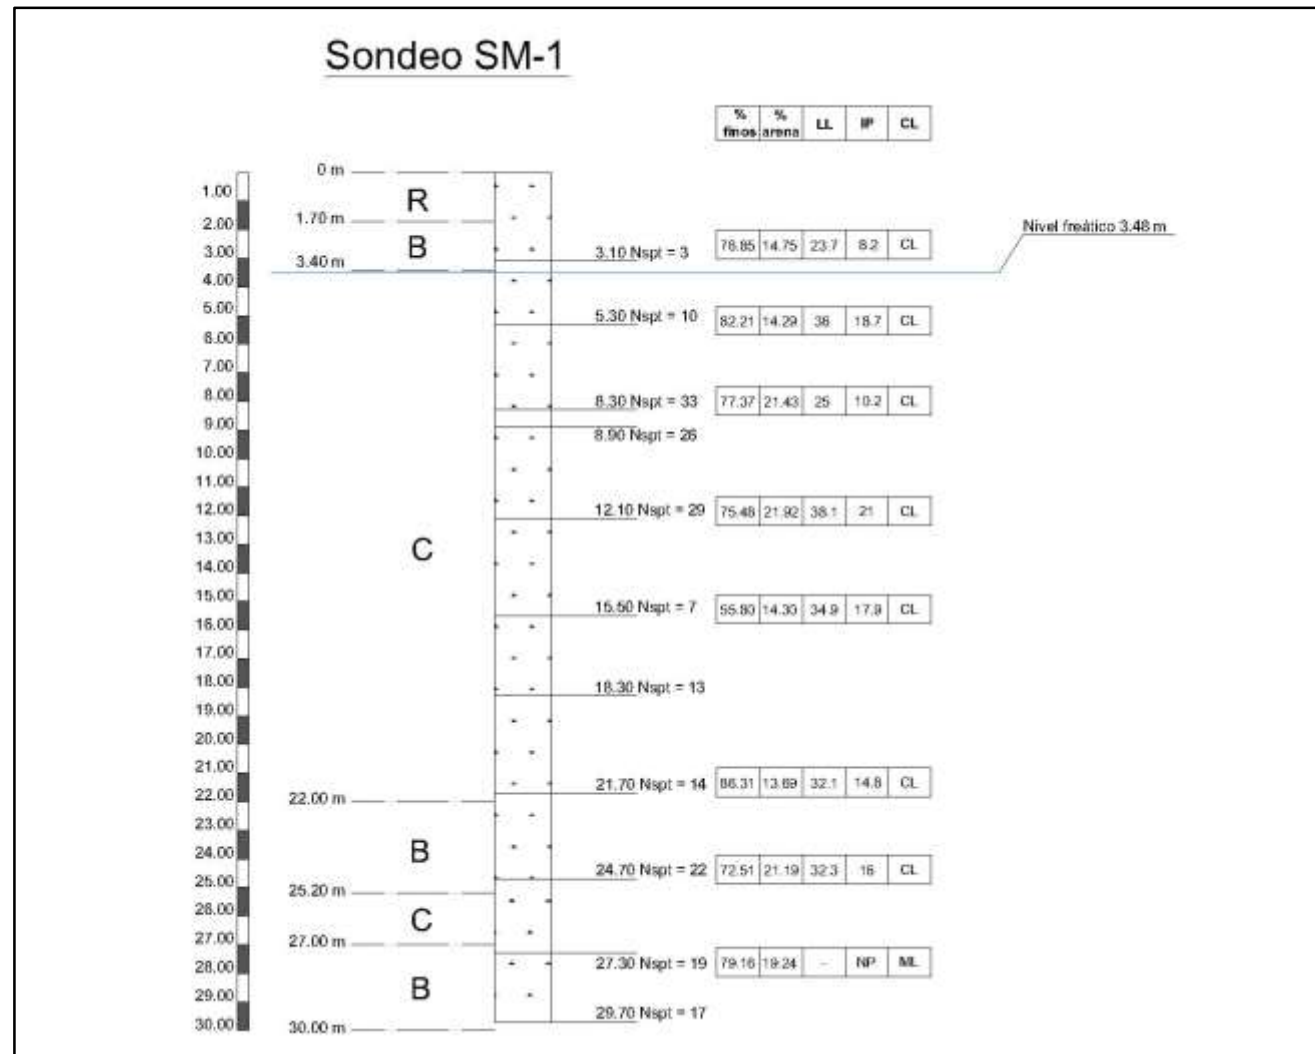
Características del terreno en el estribo 1. Fuente: Imagen realizada con AutoCAD.
